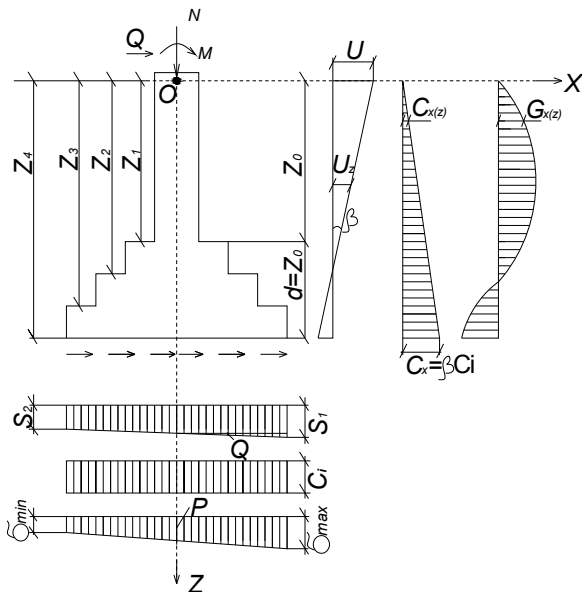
Расчетная схема внецентренно нагруженного фундамента
